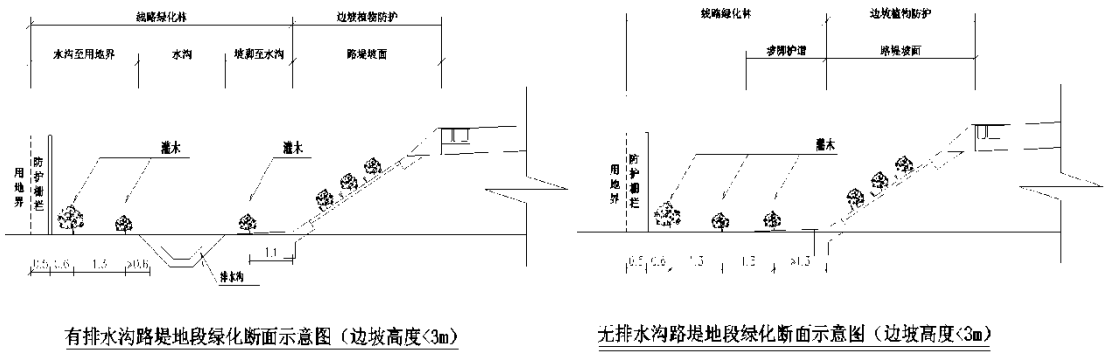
路堤地段绿化断面示意图 (边坡高度<3m)
